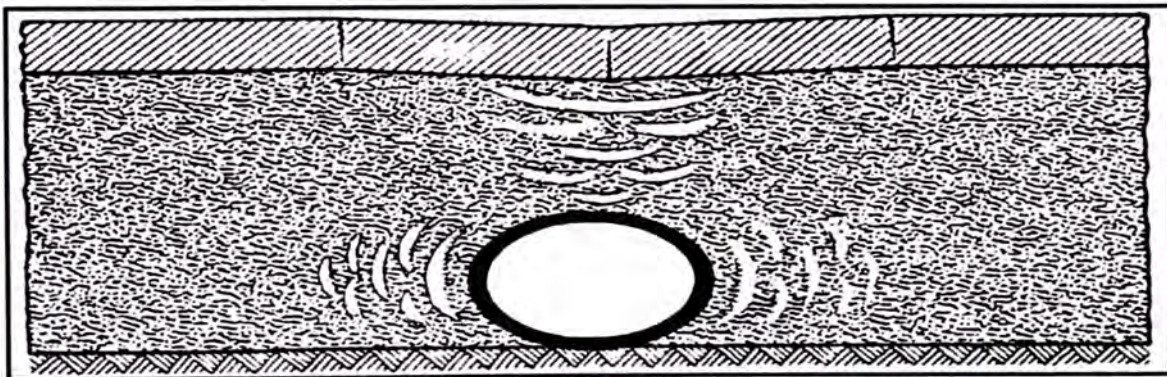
Falla del pavimento, debido a una inadecuada compactación o a la baja calidad del material circundante a la alcantarilla flexible.
